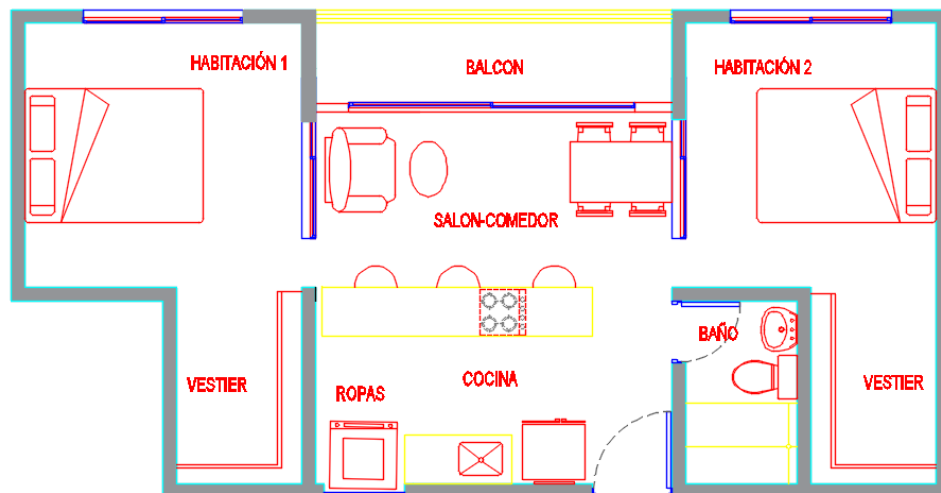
Diseño arquitectónico apartamento tipo loft.
